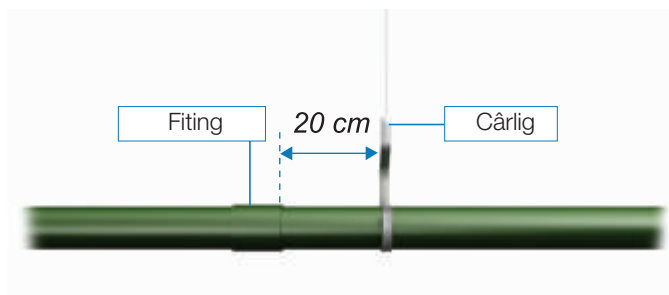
Distanța minimă de la un cârlig la un fitting este 20cm.
